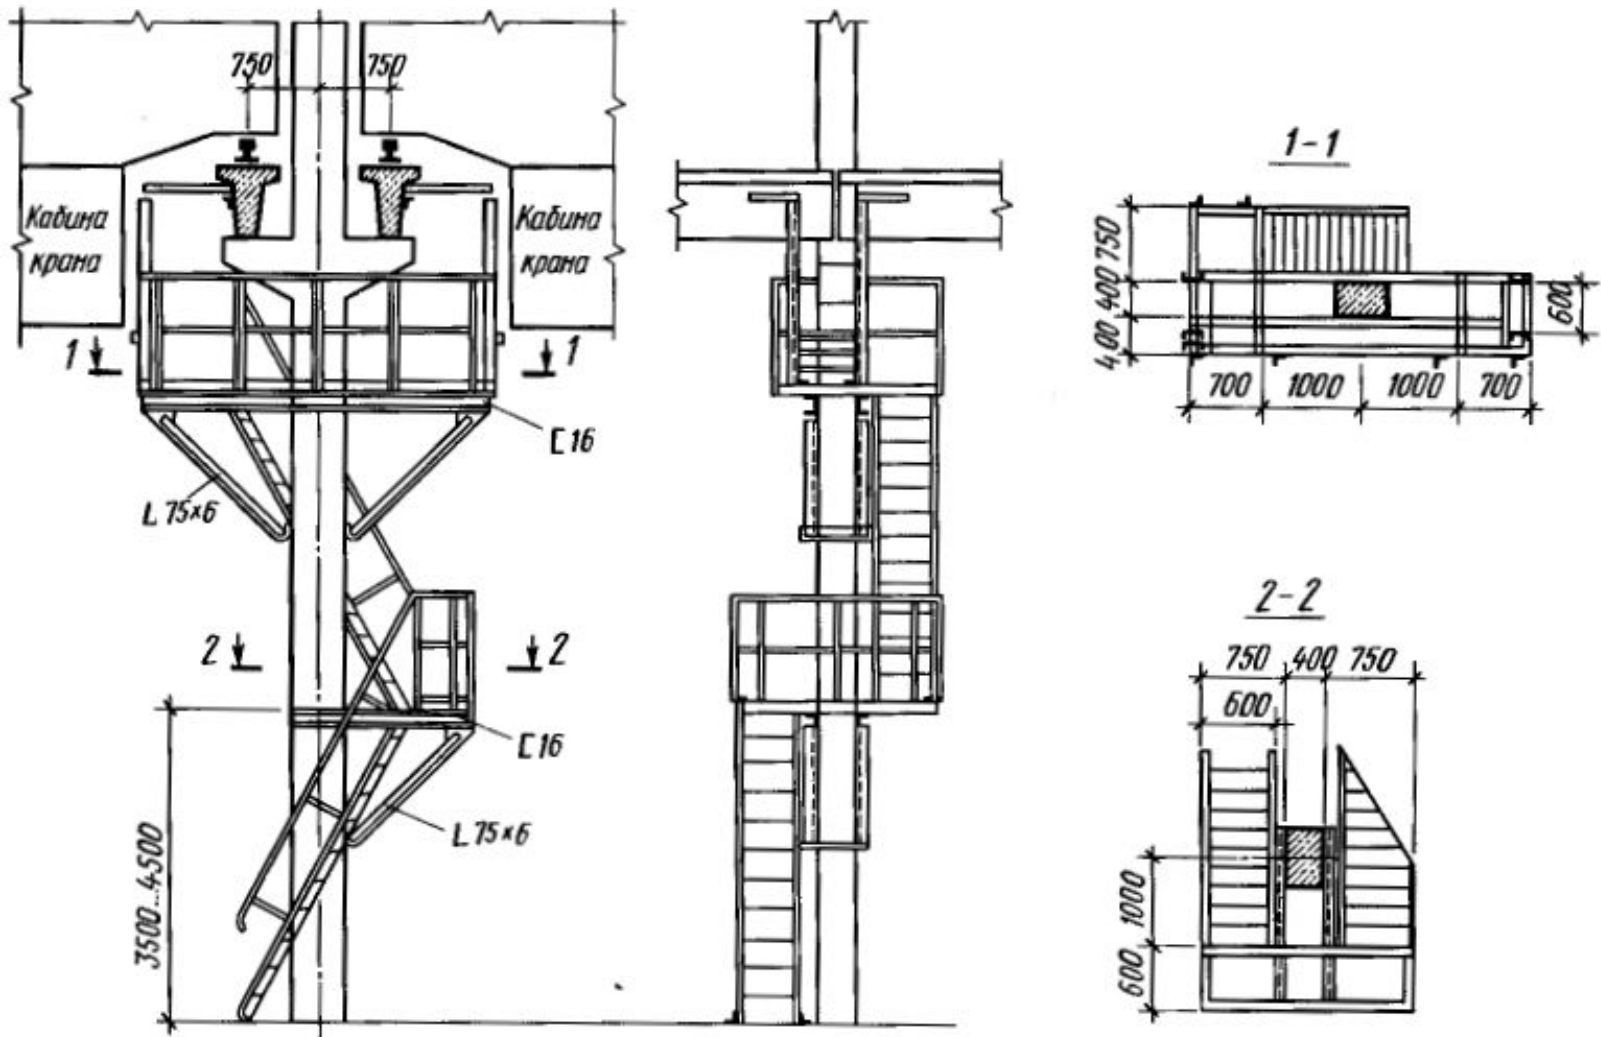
Устройство служебной лестницы и посадочной площадки для мостового крана у внутренней колонны цеха
